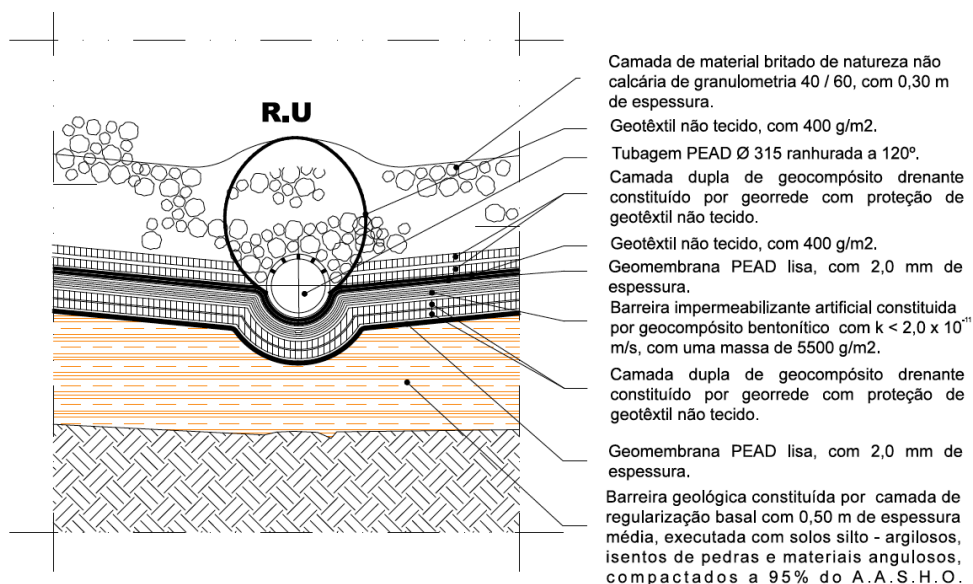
Pormenor do dreno de recolha de lixiviados do sistema alternativo.
